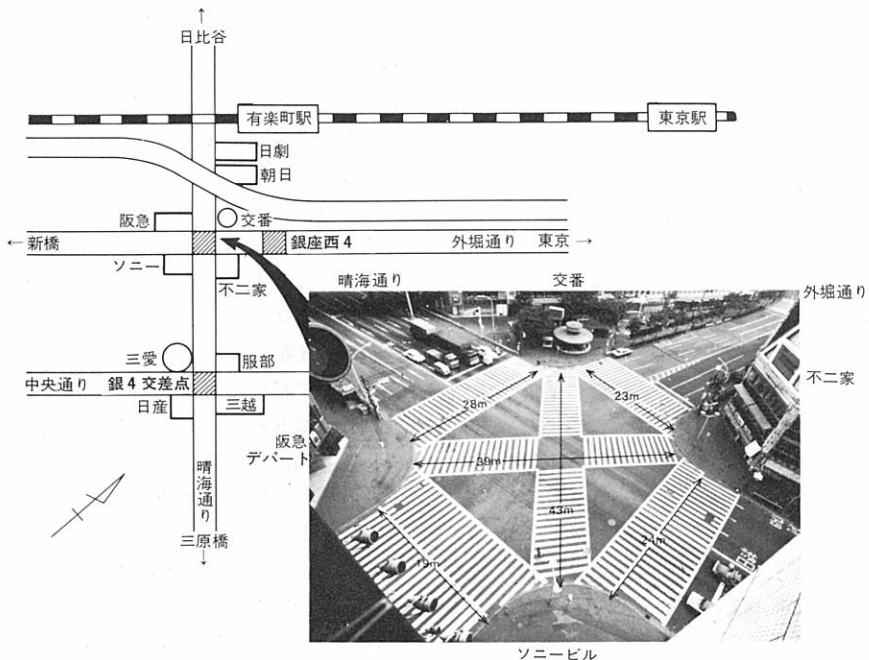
スキヤ橋交差点の位置と全景 Sukiya-bashi intersection—a street map and an aerial view from the top (9th floor) of the Sony building
